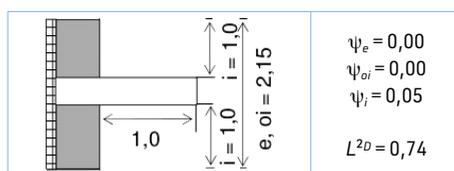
Ponte termico lineare soletta-pavimento (cappotto esterno)
